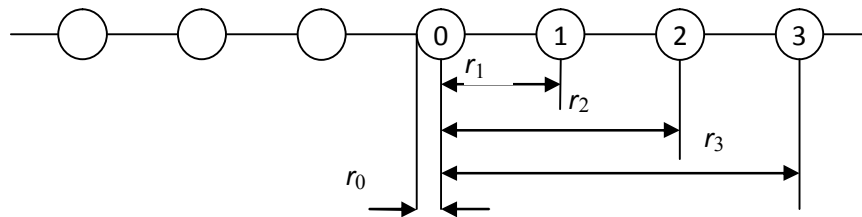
Однорядный ленточный фундамент на основе свай-РИТ:
